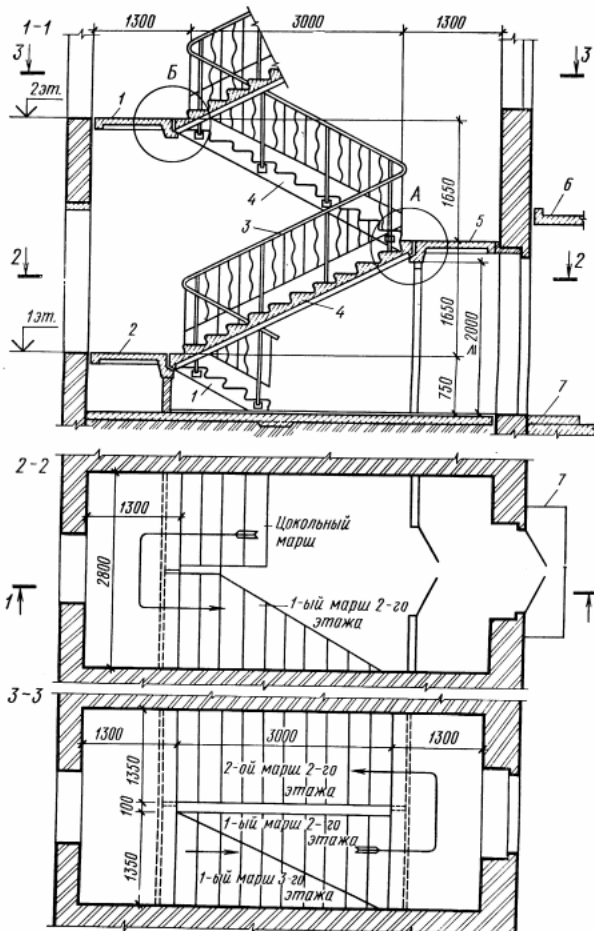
Двохмаршові сходи (розріз і плани за поверхами):
